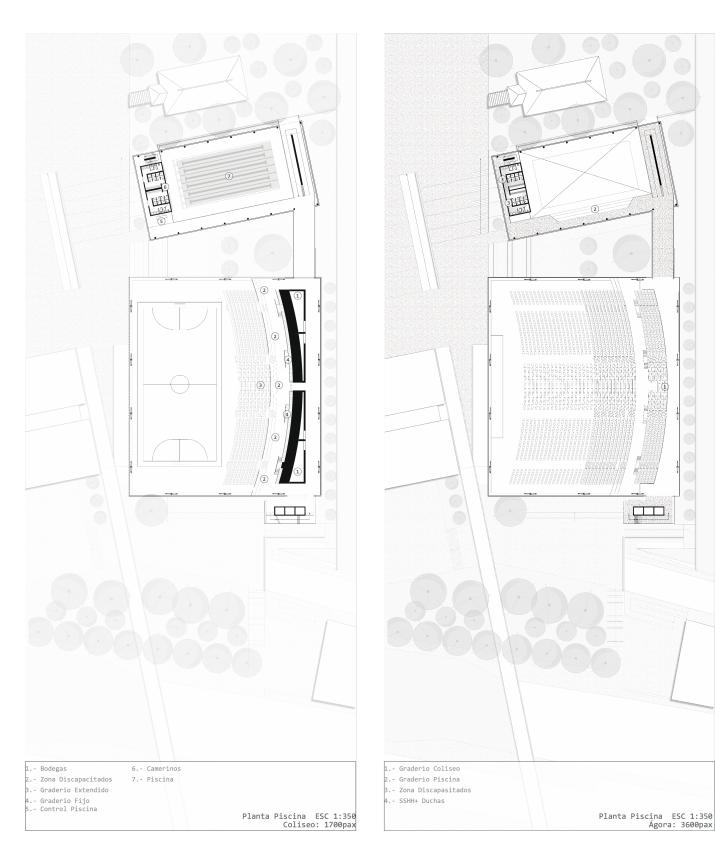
Planta piscina(+12.00) y planta graderios(+16.00)
